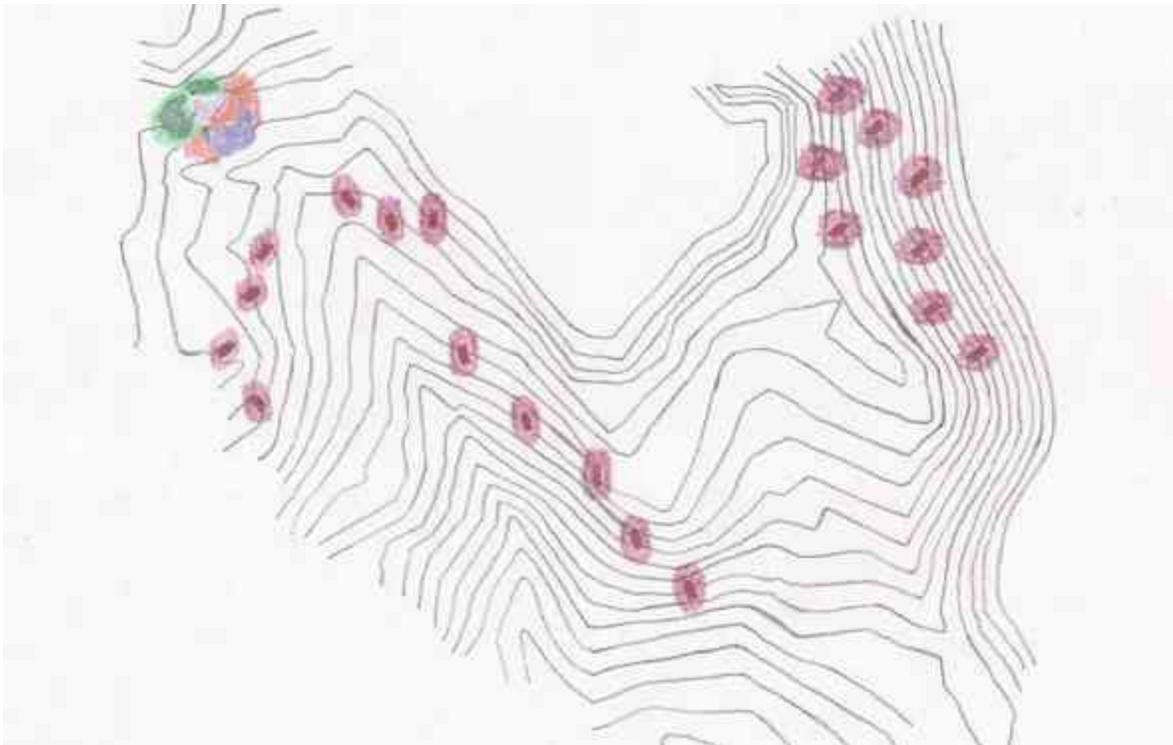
Planta de conjunto del "HOTEL ENDÉMICO" Fuente: <http://www.archdaily.mx/mx/02-130223/hotel-endemico-graciastudio>
